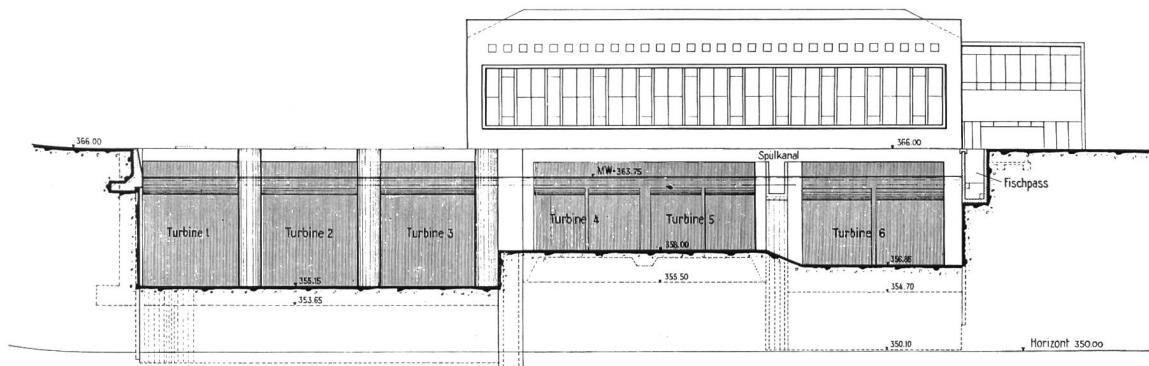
Oberwasserseitige Ansicht der heutigen Kraftwerksanlage Rüchlig. Maßstab 1:600.
